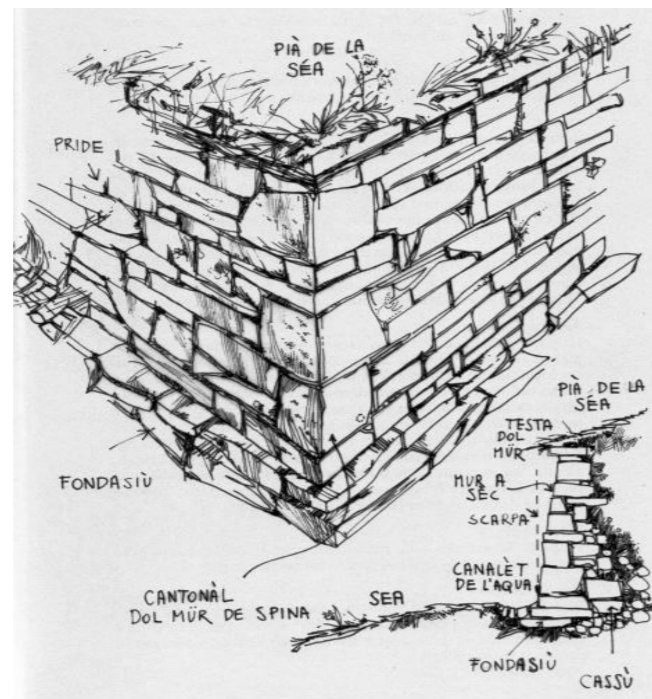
Schema muretto a secco in dialetto, foto presa da www.ruralpini.it
